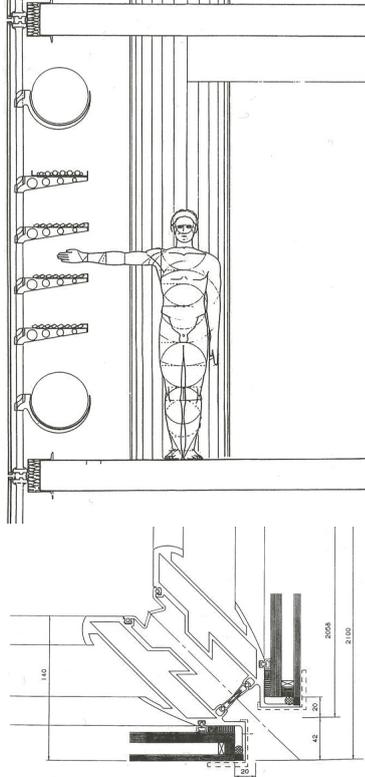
Hotel Industrial Berlier: Arriba: Sección por fachada; abajo: sección horizontal por esquina.
